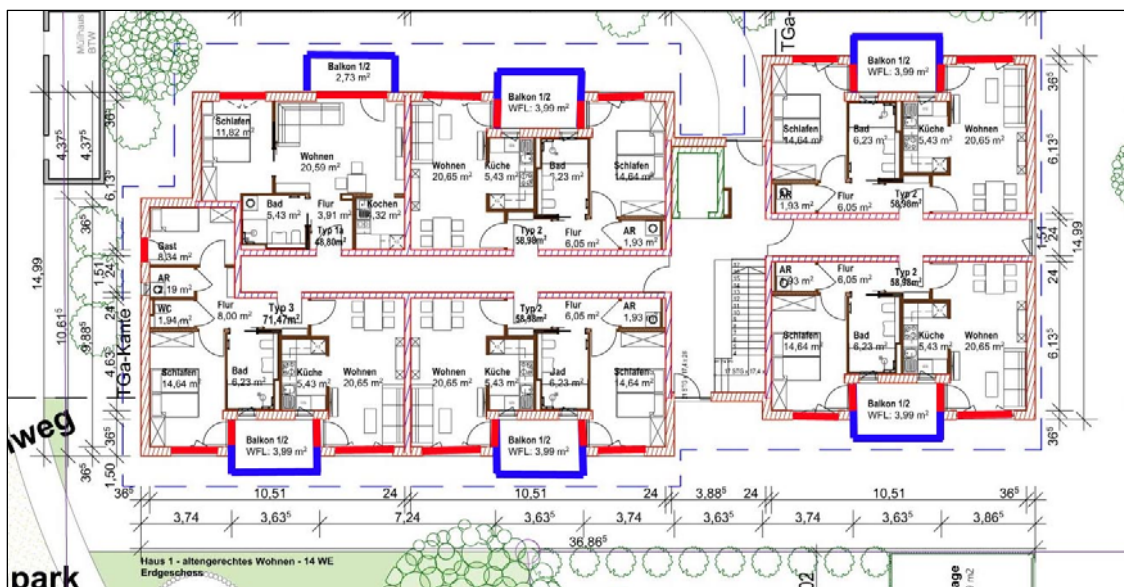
Grundriss Erdgeschoss, Haus 1 (altengerechtes Wohnen) /66/
